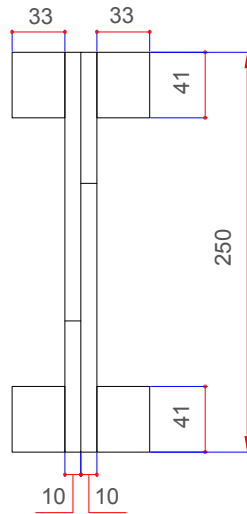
Vigas de madera laminada. Fuente: Egaña (2016).
